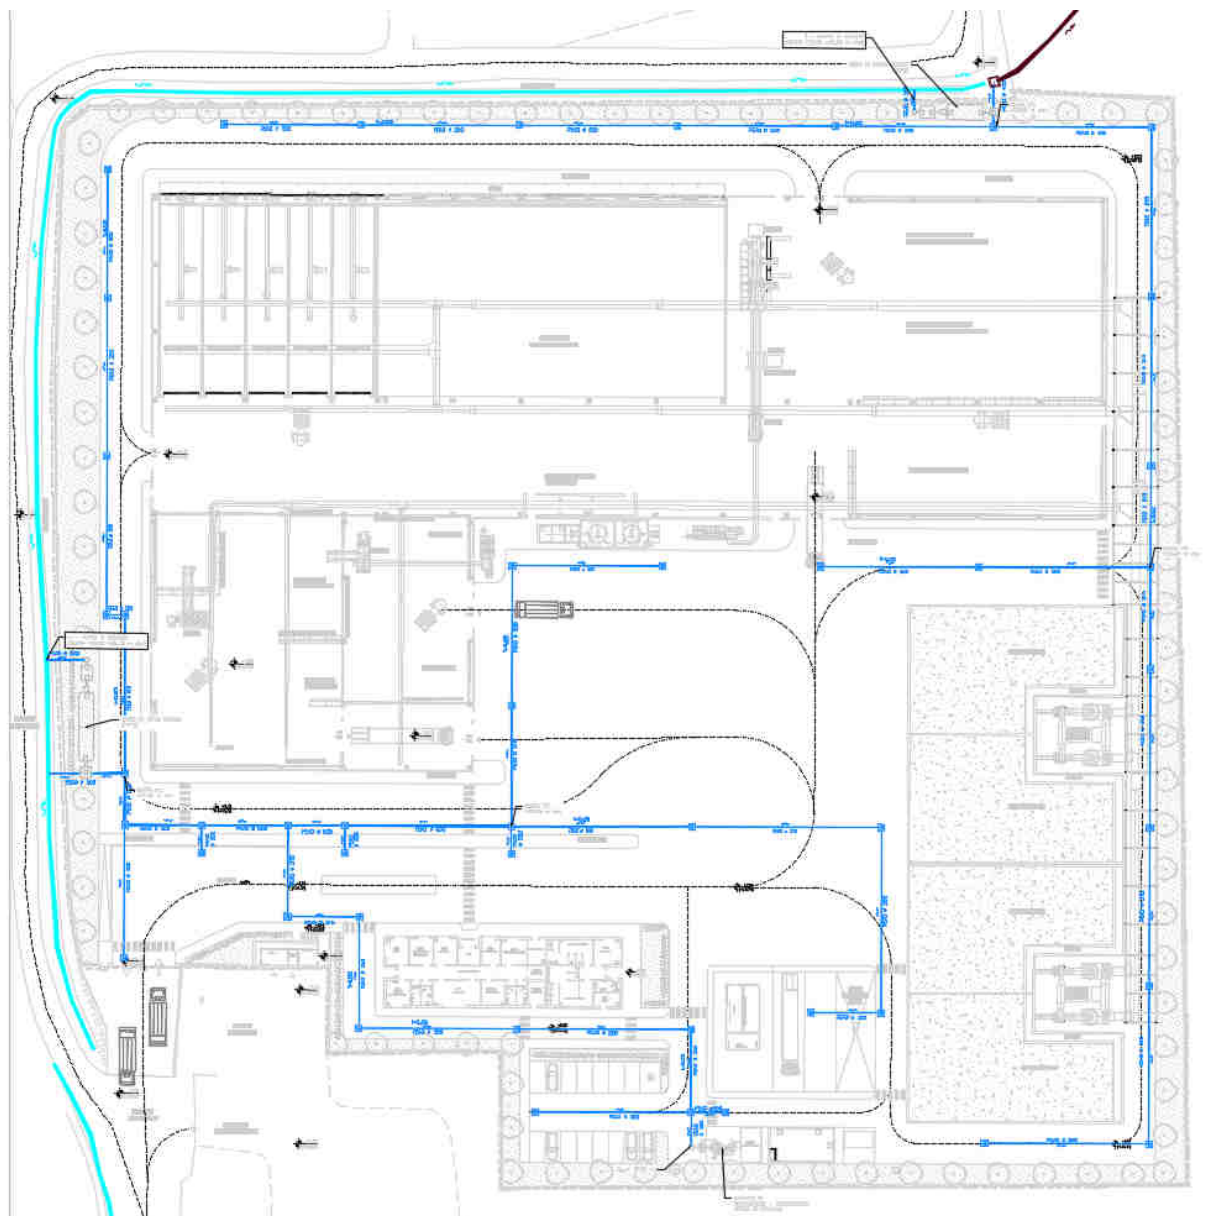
Rete drenaggio acque meteoriche dei piazzali e delle strade.
